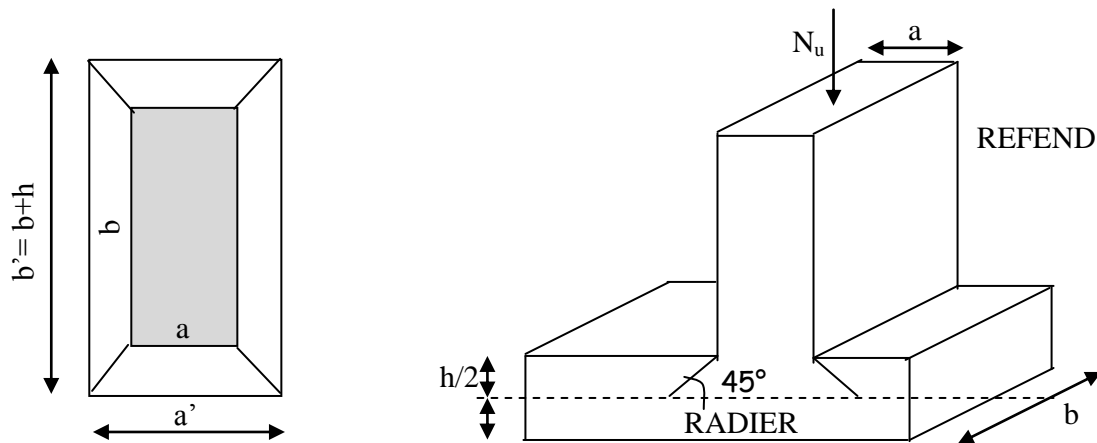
Périmètre utile des voiles et des poteaux
